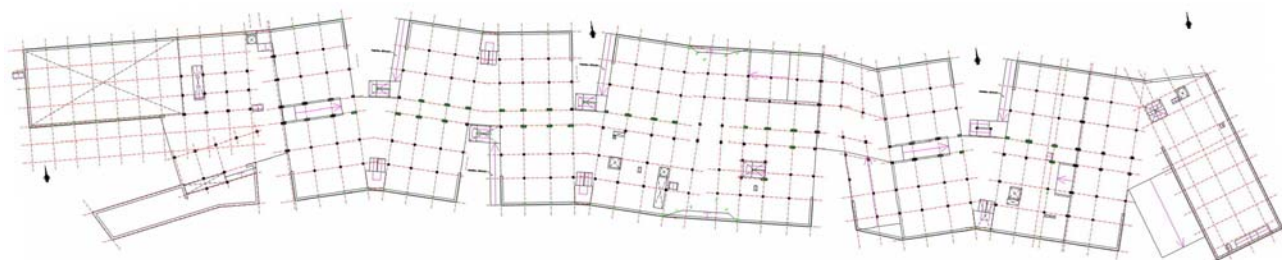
Vista de la planta baja de las Escuelas de Artes y de Diseño
